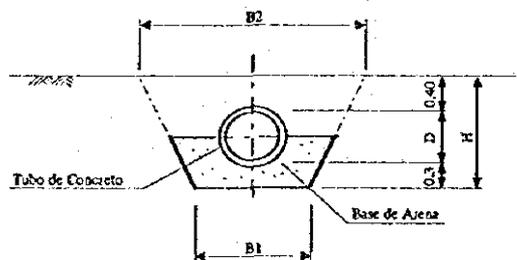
Obra de Alcantarillado del Camino (Tipo-I)
